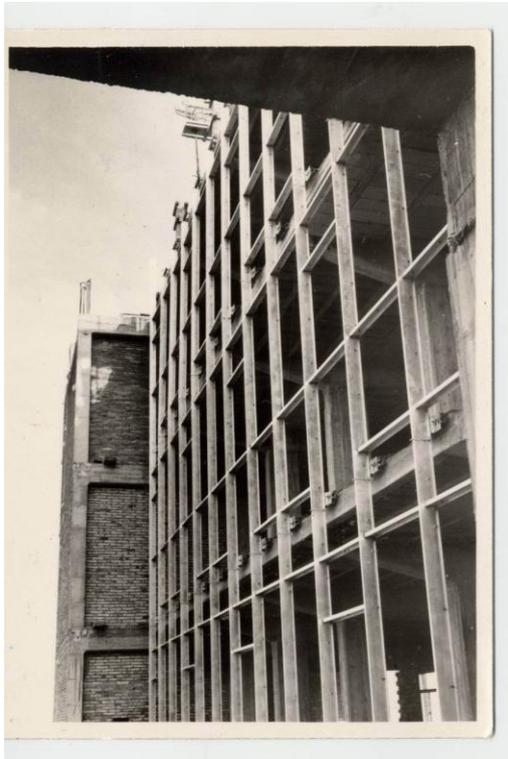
y Fig. 122. Dos fotografías de la fachada noroeste en construcción. *Archivo Escuelas San José.
